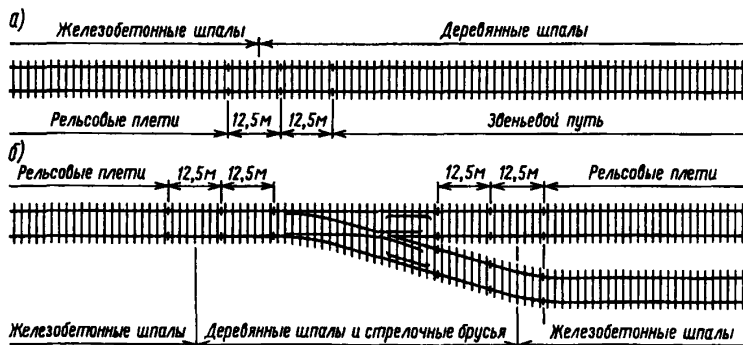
Схемы примыкания бесстыкового пути на железобетонных шпалах к звеньевому пути (а) и к стрелочному переводу (б)
